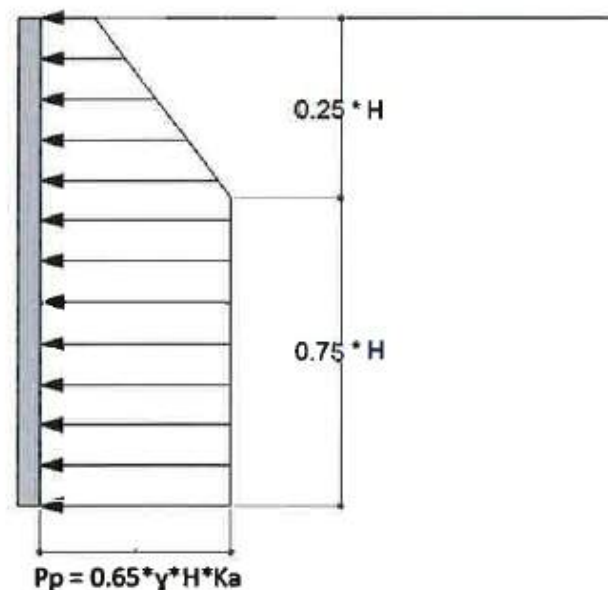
Esquema de empujes trapezoidales que deben soportar las estructuras de contención.
